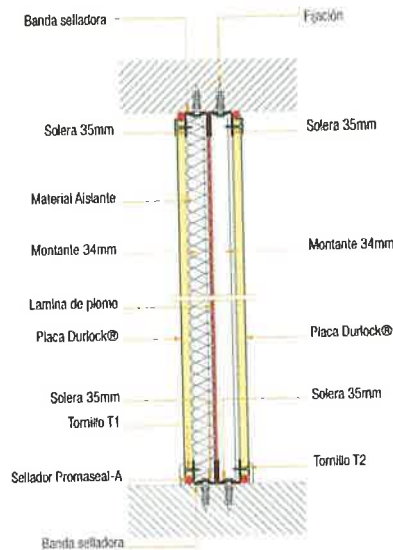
Vista en planta de paquete de tabiquería blindada – corte vertical.
